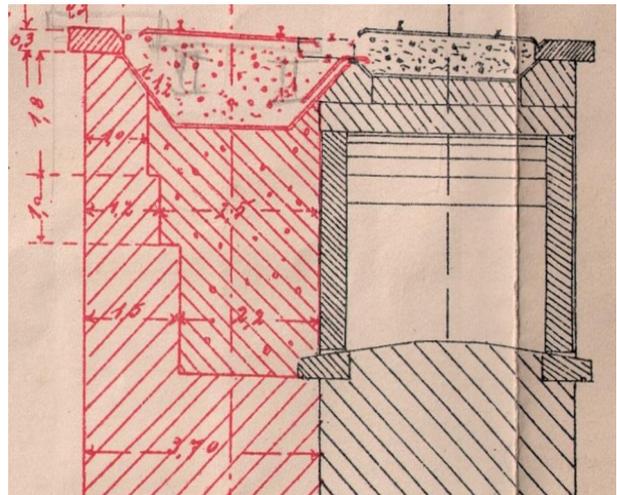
Pfeilerquerschnitt aus Bestandsplan, rot: westliches Teilbauwerk ohne Spargewölbe, schwarz: östliches Teilbauwerk mit Spargewölbe
